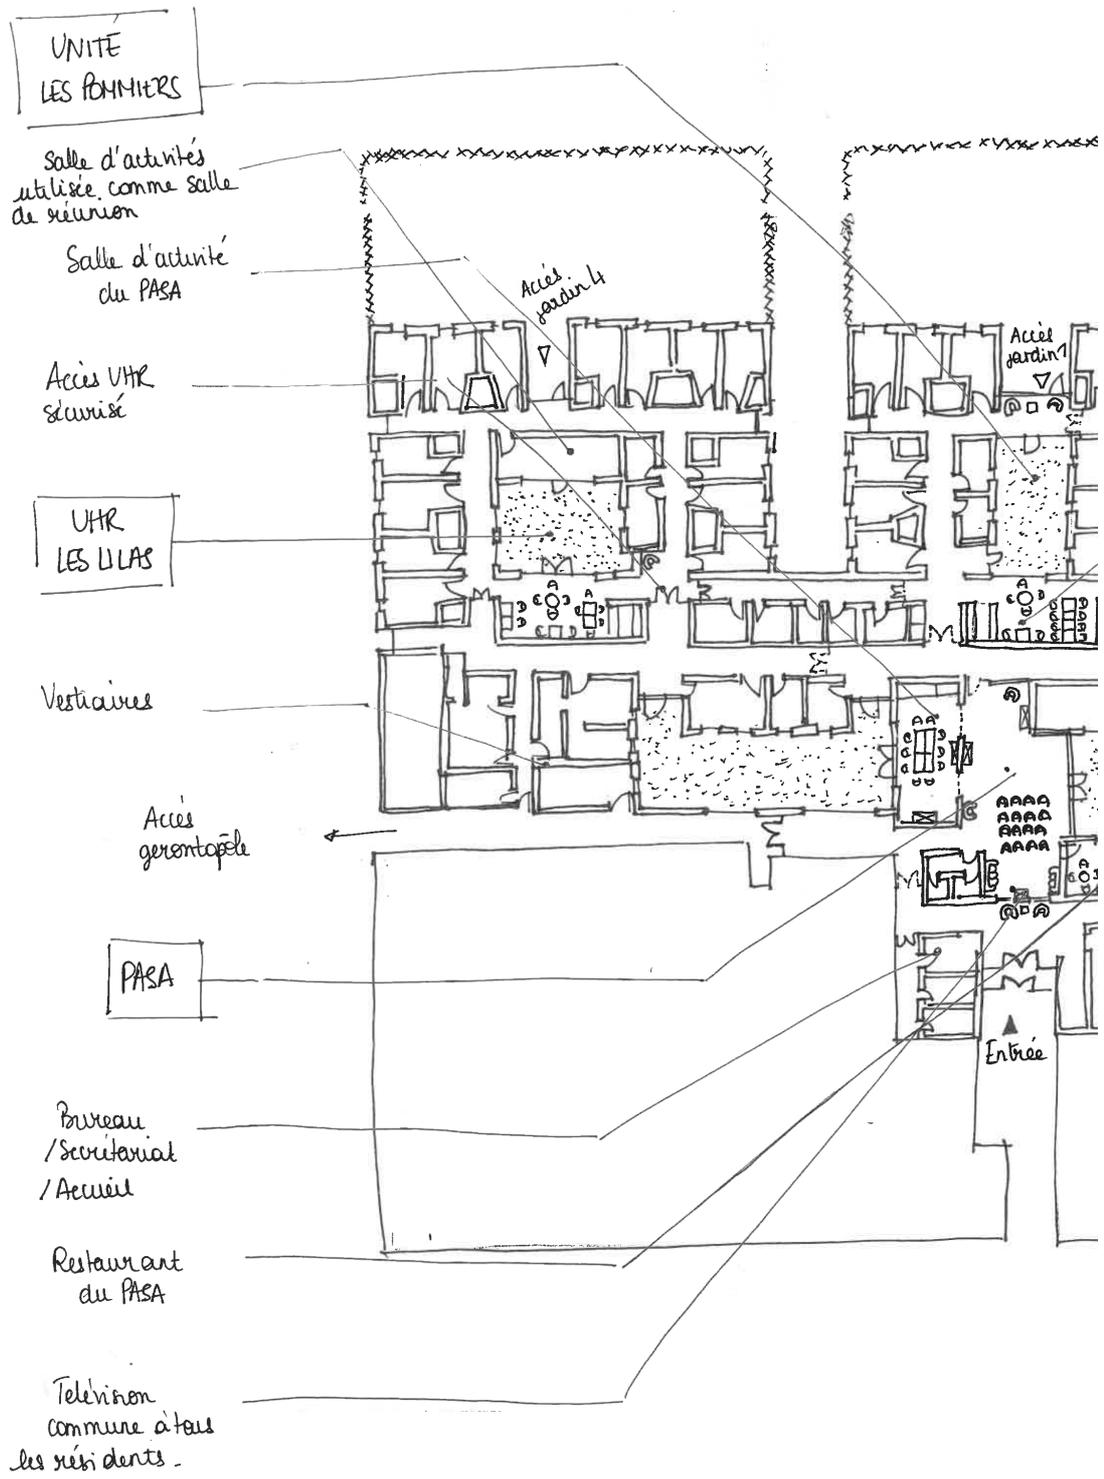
Le Bois aux Bécasses- Plan masse de l'établissement
